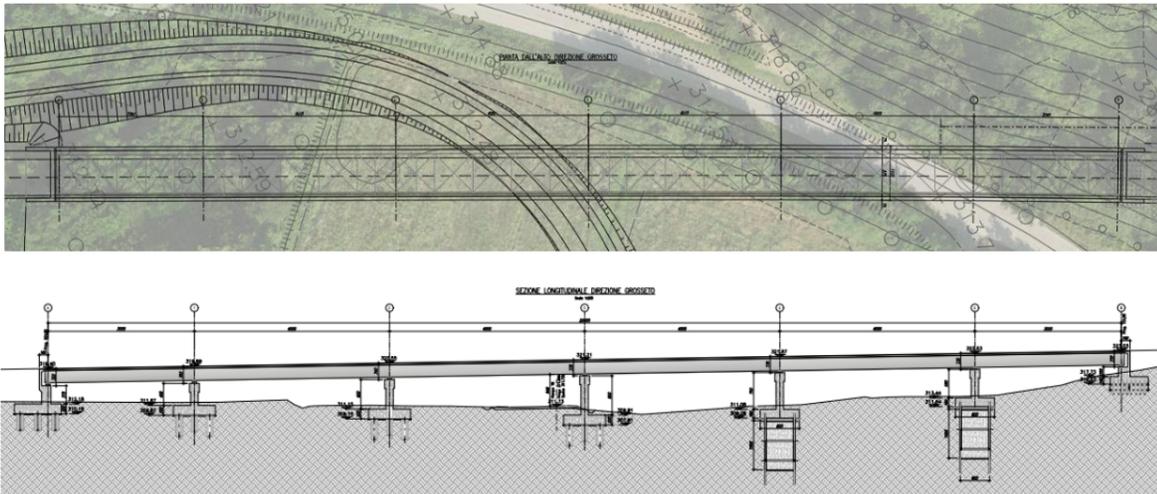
Pianta e profilo longitudinale carreggiata direzione Grosseto
